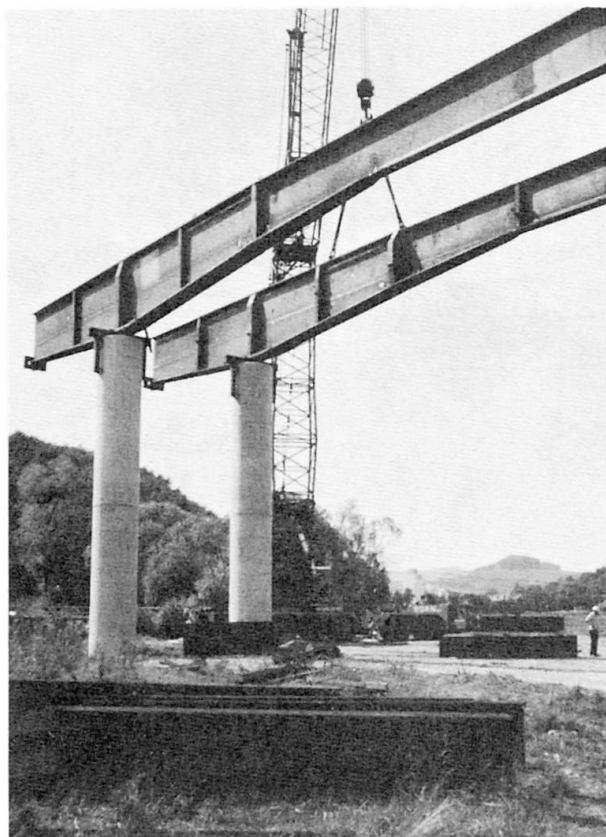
Poutres maîtresses reposant sur les piles 4 en cours de montage
